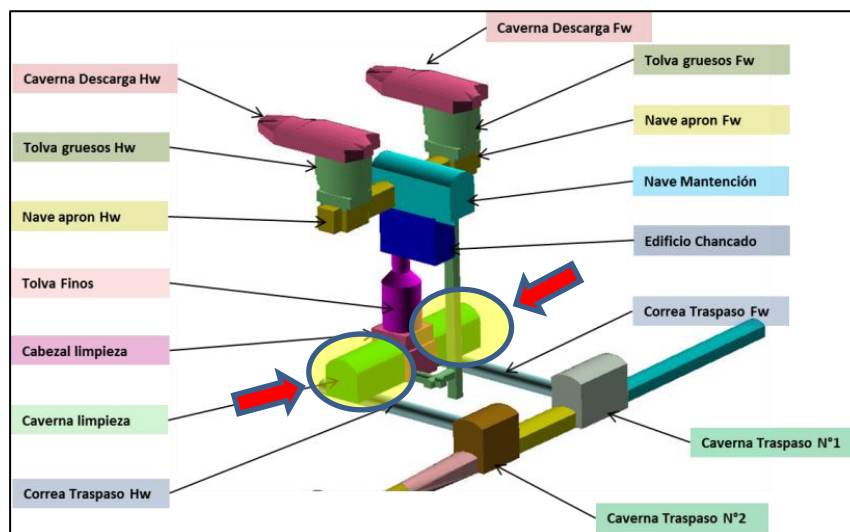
Correas de Limpieza en Planta Chancado.
